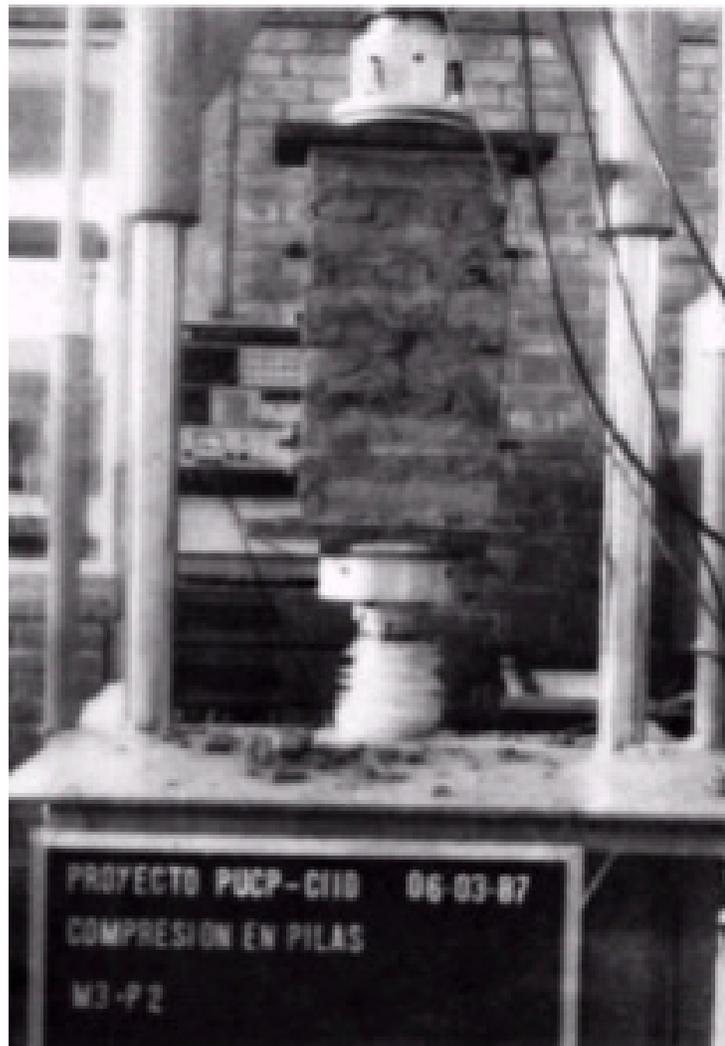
Ensaio de compressão em pilares de adobe.
